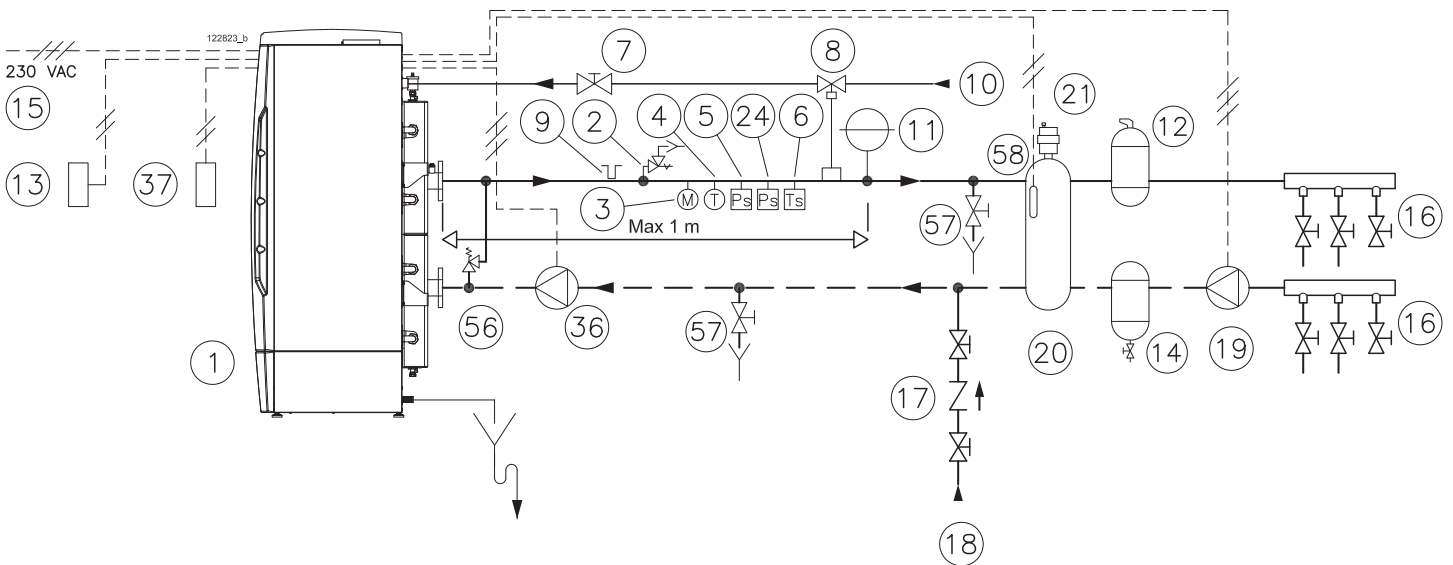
Exemple du schéma de raccordement de la chaudière
